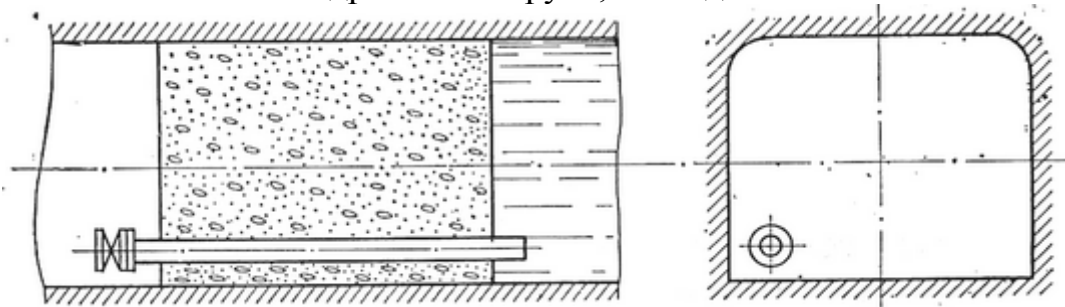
Схема безрубцовой прямоугольной водонепроницаемой перегородки
